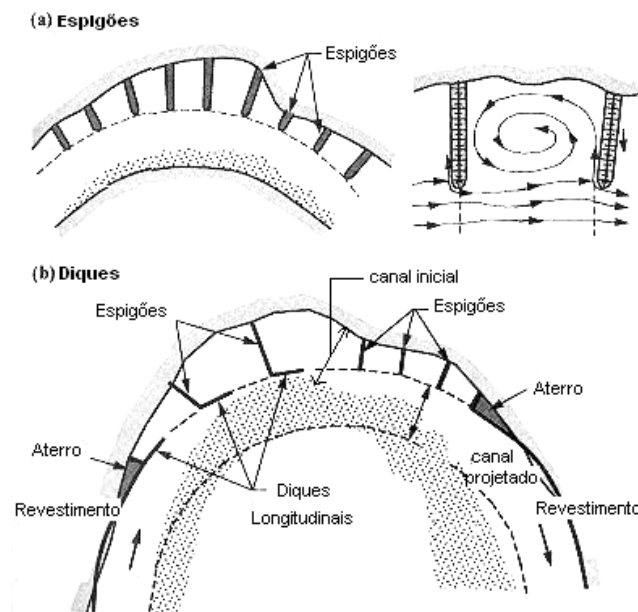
Regularização dos leitos – Disposição em planta dos diques e espigões
